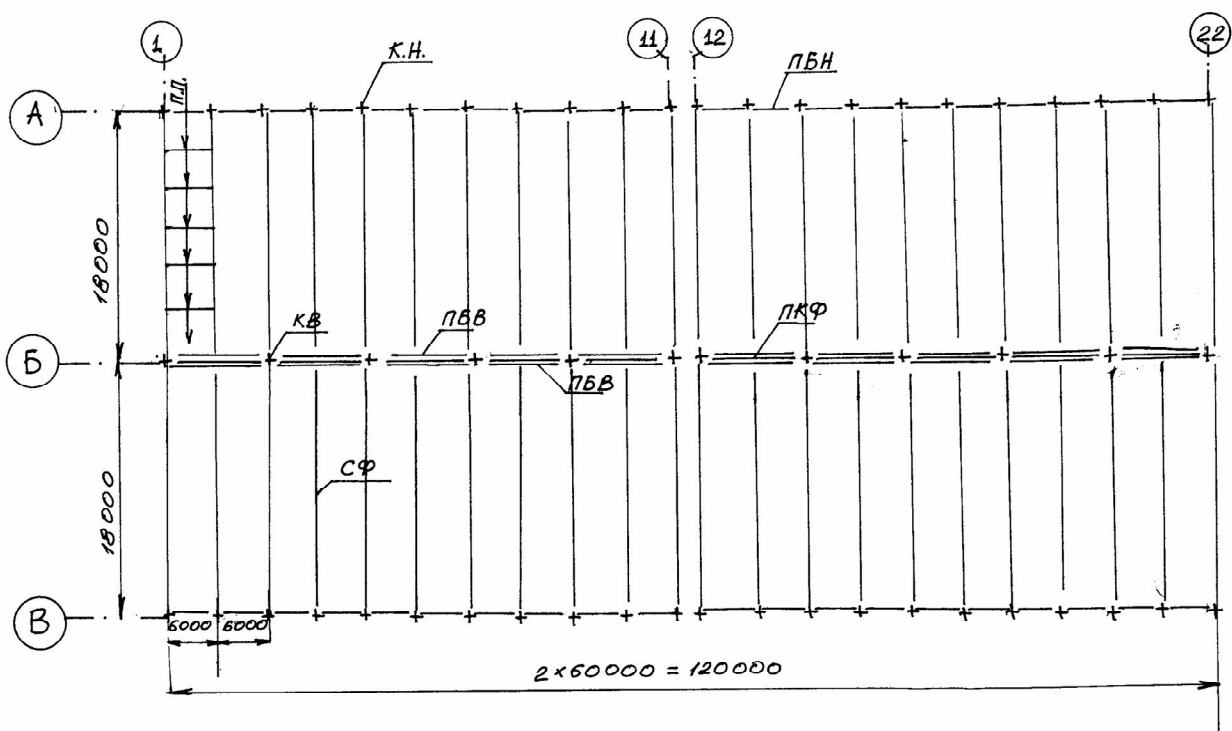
Компонувачна схема об'єкта: КН, КВ – колони наружні та внутрішні; ПБН, ПБВ – підкранові балки наружного та внутрішнього прогонів; ПФ, СФ – підкрюк'яні і крок'яні ферми; ПП – плити покриття
